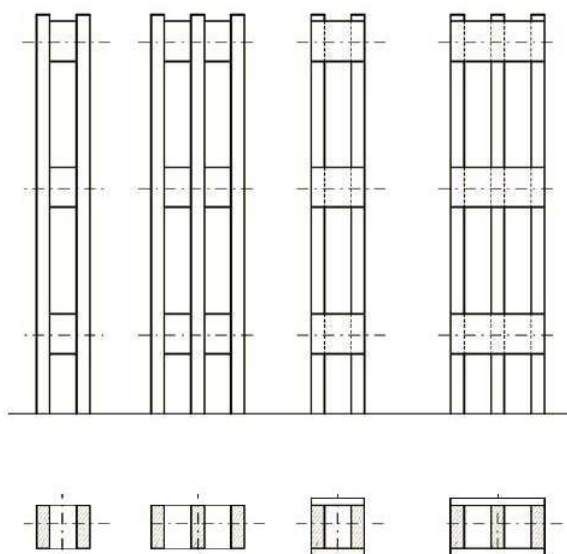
Pilares espaçados. Adaptado de [ 3 ].
